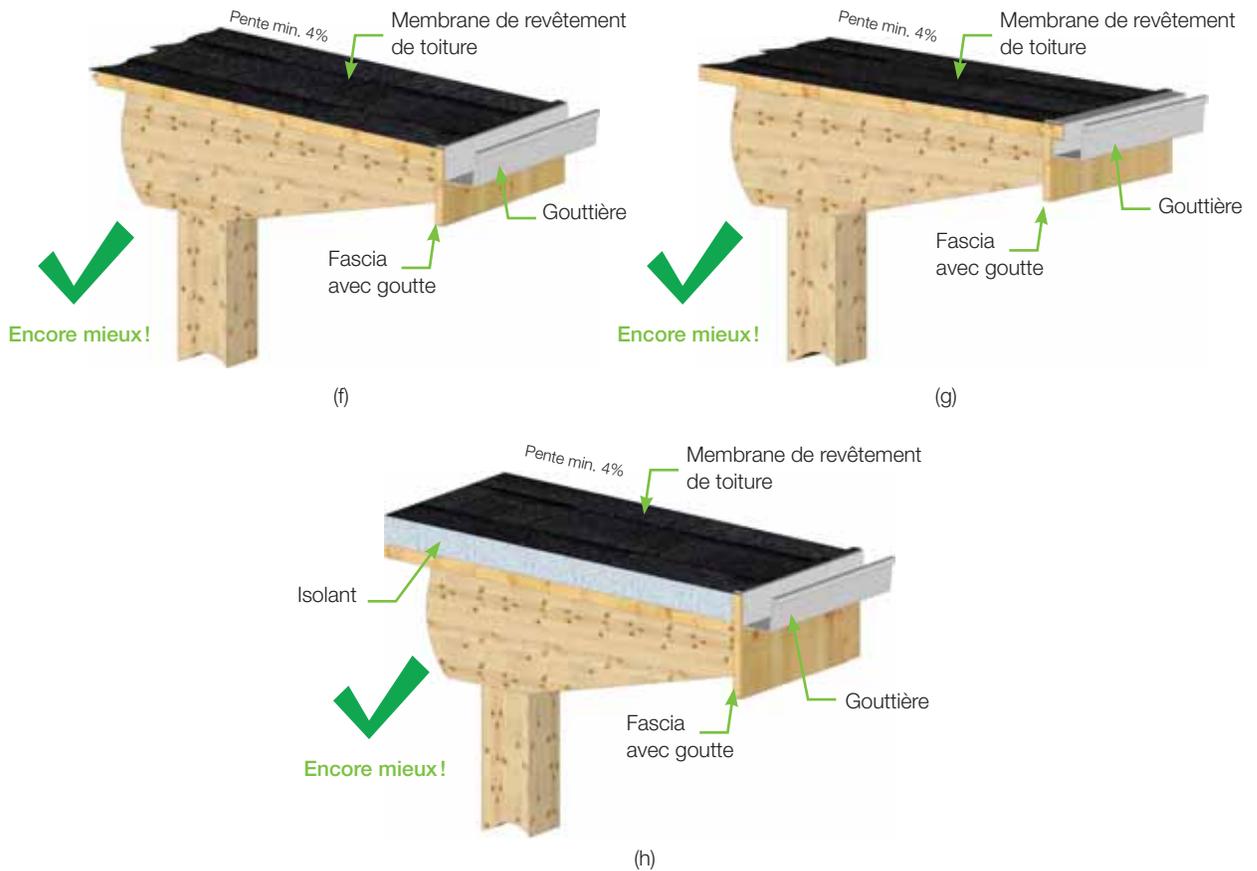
• Protection d'une poutre extérieure en bois (suite)
